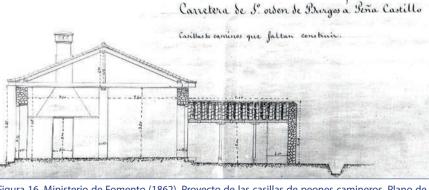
Ministerio de Fomento (1862). Proyecto de las casillas de peones camineros. Plano de alzado lateral de casilla caminera tipo a construir en la carretera Burgos-Peñacastillo (detalle). AGA 24/2.671.
